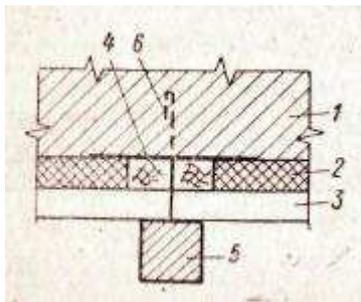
Вариант конструкции вертикального шва теплогидроизоляции из сборных дерево-асфальтобетонных панелей (к п. 3.39)
